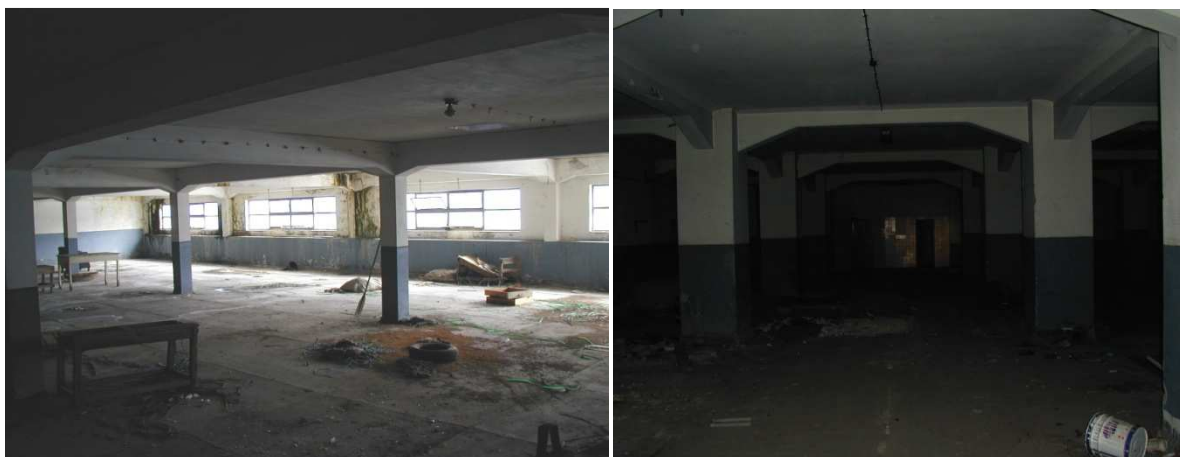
Situação encontrada no interior antes da intervenção de reconversão.
